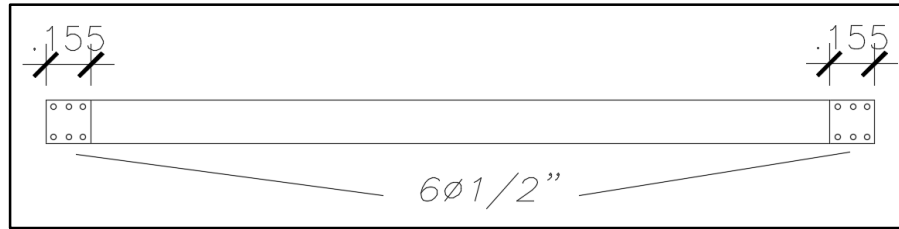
Longitud de las cabezas del muro de corte y el refuerzo de acero
